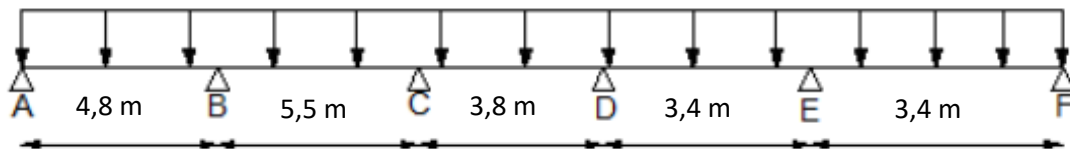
Schéma statique de la poutre reposant sur six appuis.
